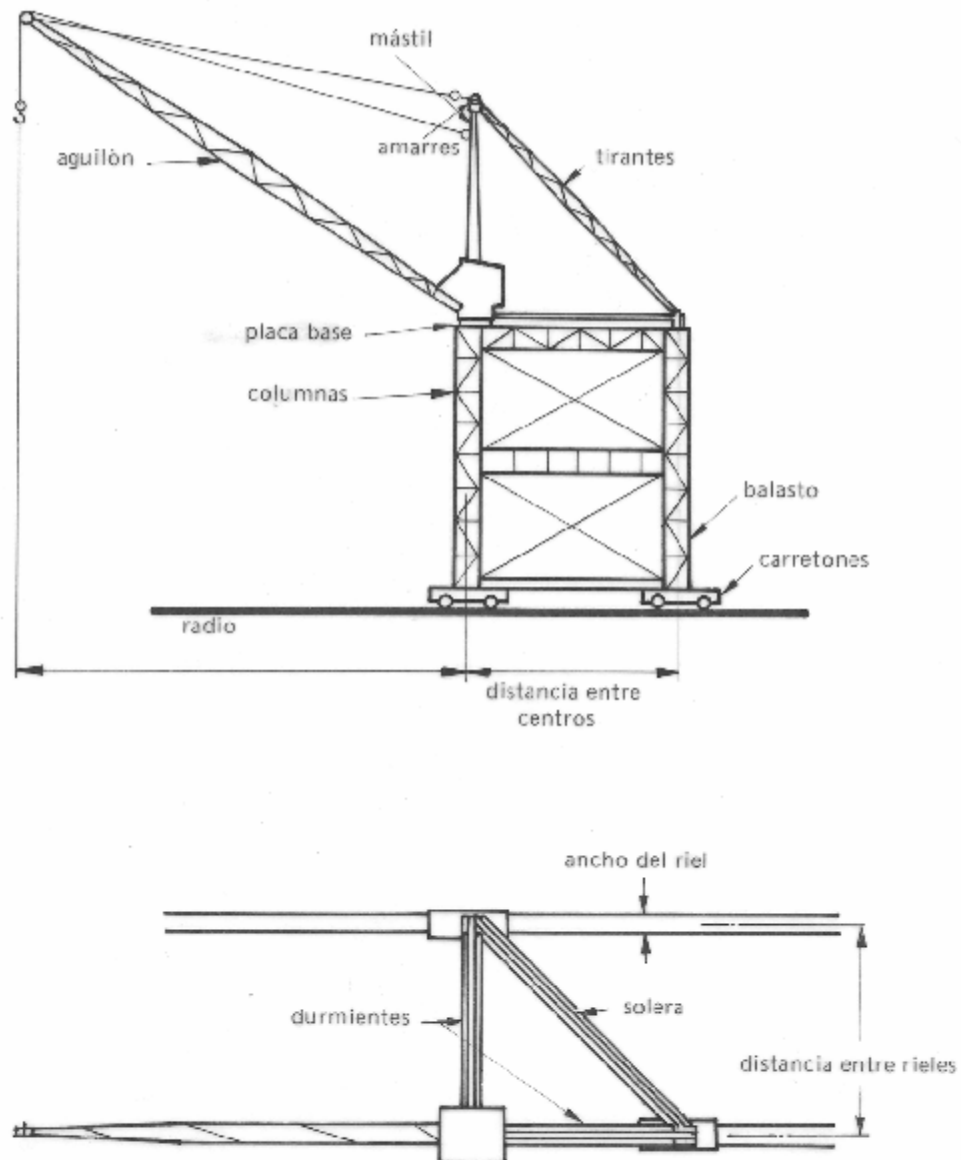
Grúa de pescante montada sobre columnas y carretones.
